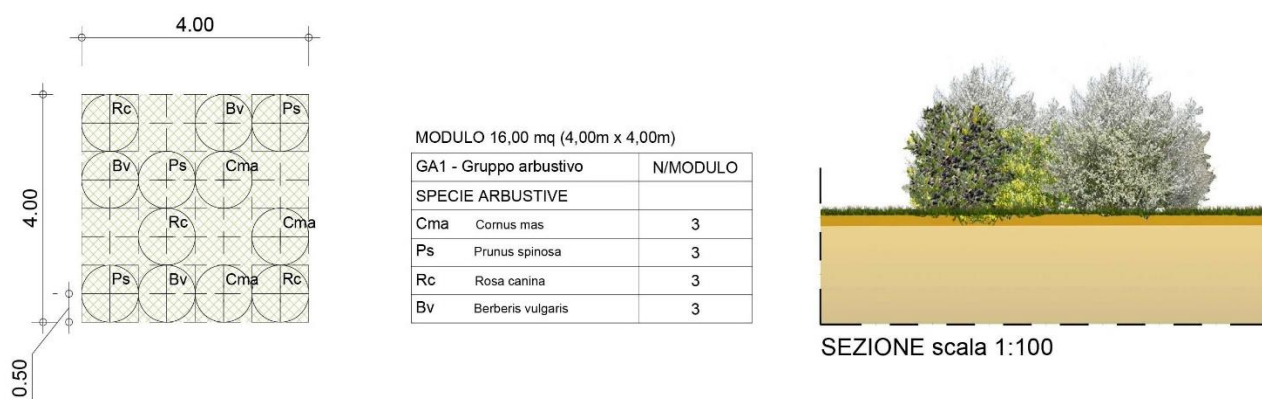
Pianta e sezione gruppo arbustivo tipo 1
